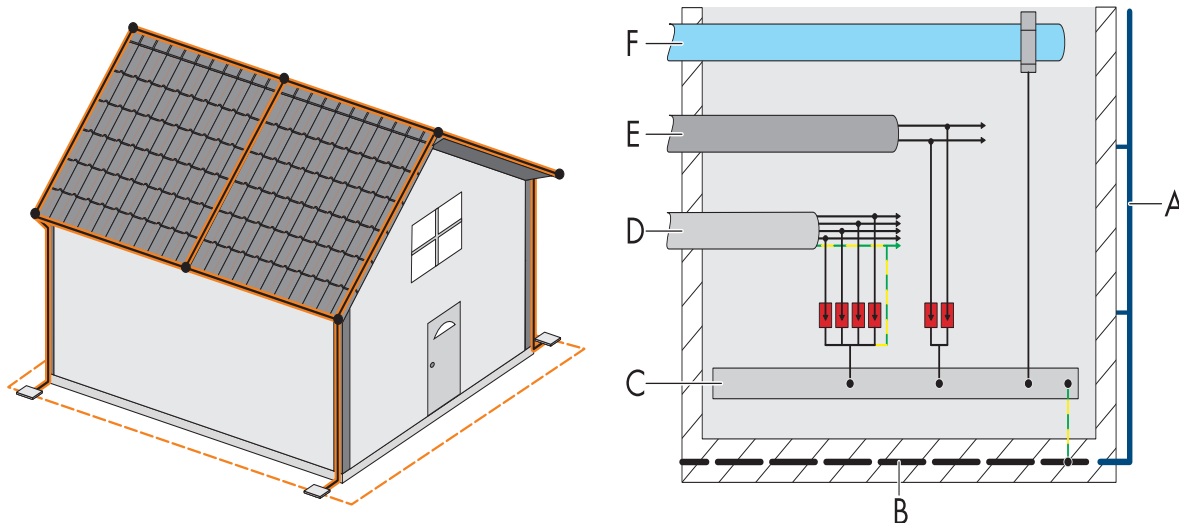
Äußerer Blitzschutz (links) und innerer Blitzschutz (rechts). Legende: A: äußerer Blitzschutz (mit Anschluss an den Fundamenterder), B: Fundamenterder, C: Potentialausgleichsschiene, D: Netzanschluss, E: Telefonanschluss, F: Wasserleitung
